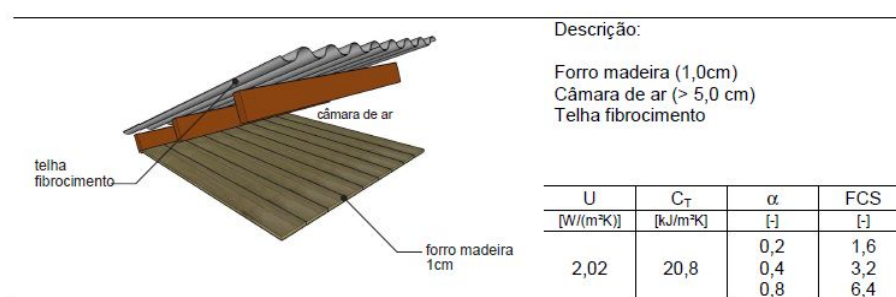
Telhado de fibrocimento com forro de madeira (LabEEE 2010)
